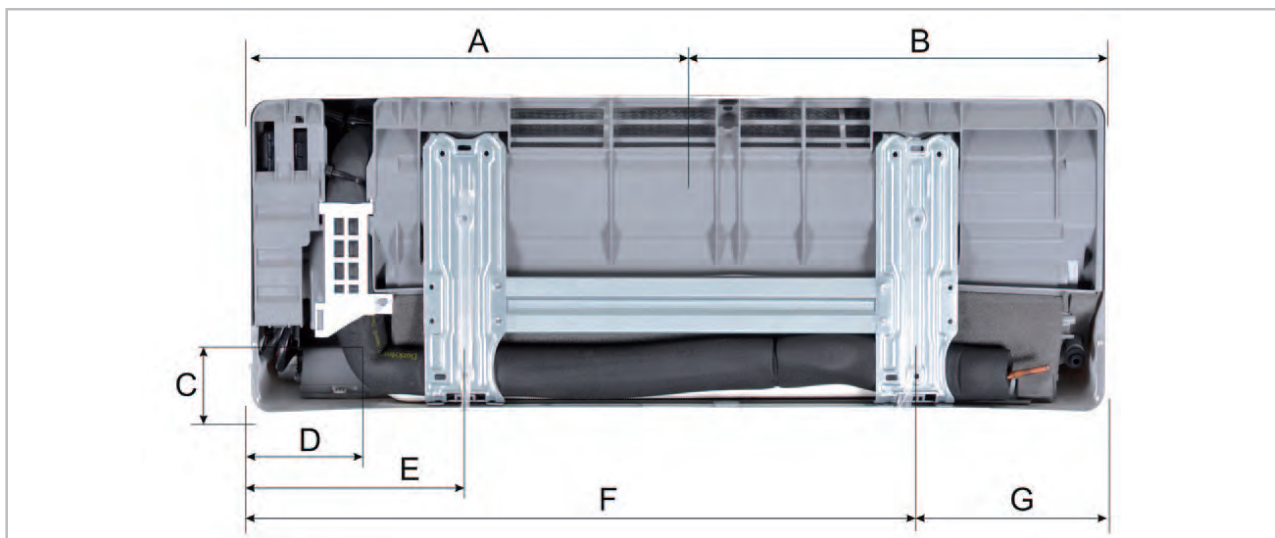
Montagepunkte der Wandhalterung MVW 222-282 (alle Maße in mm)
